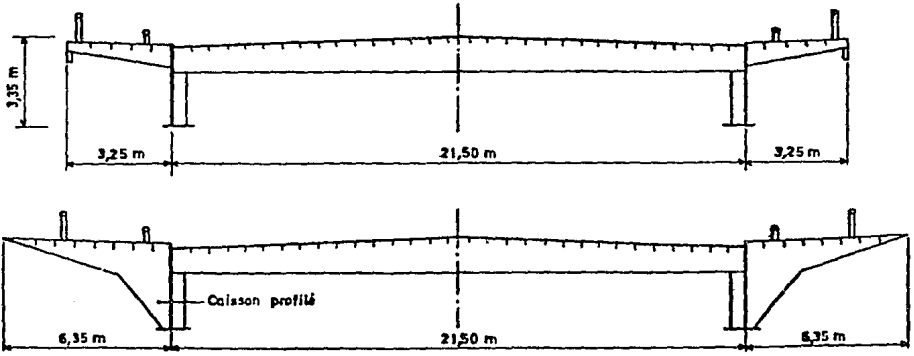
SECCION TRANSVERSAL DEL PUENTE KNEIBRUEKE.
